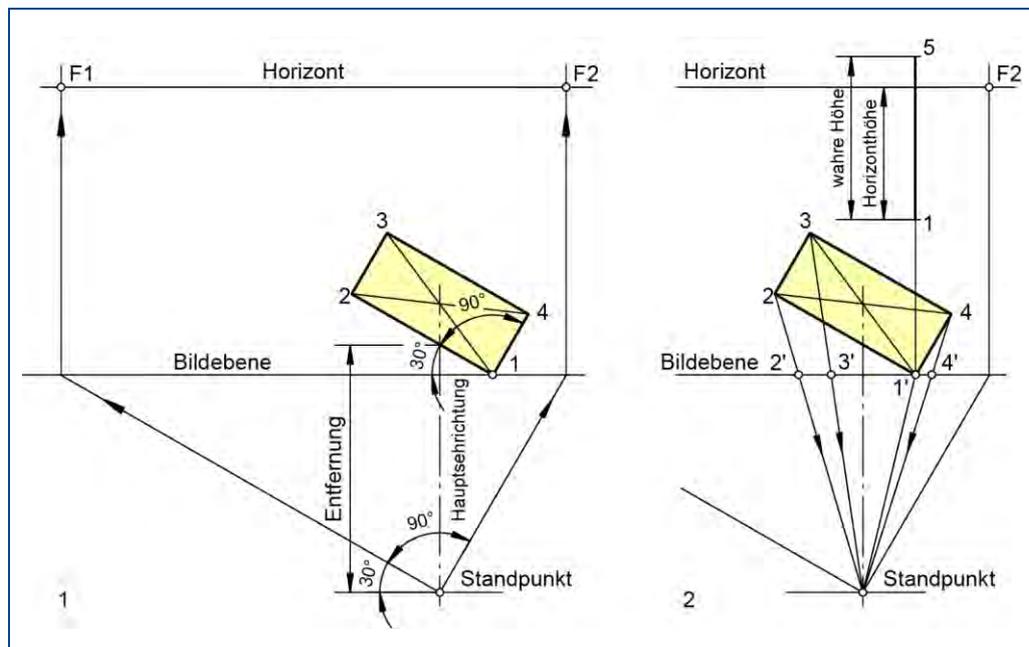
Übereckperspektive - Konstruktion aus dem Grundriss
